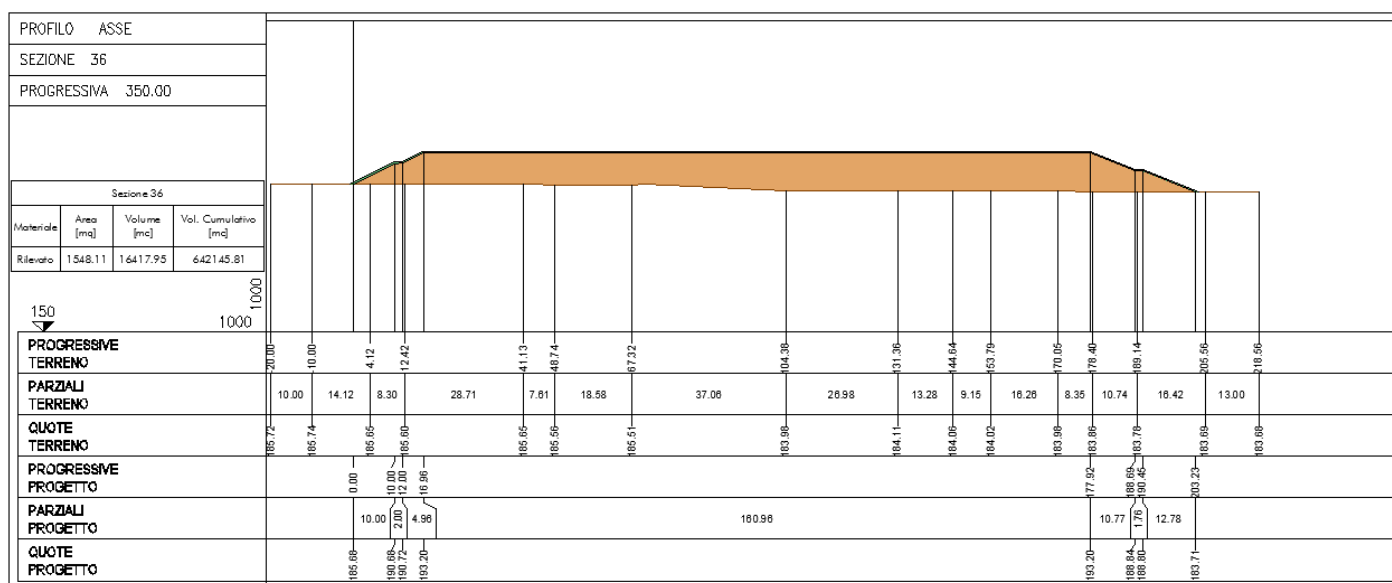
Sezione trasversale di Progetto Esecutivo dell'area di deposito
